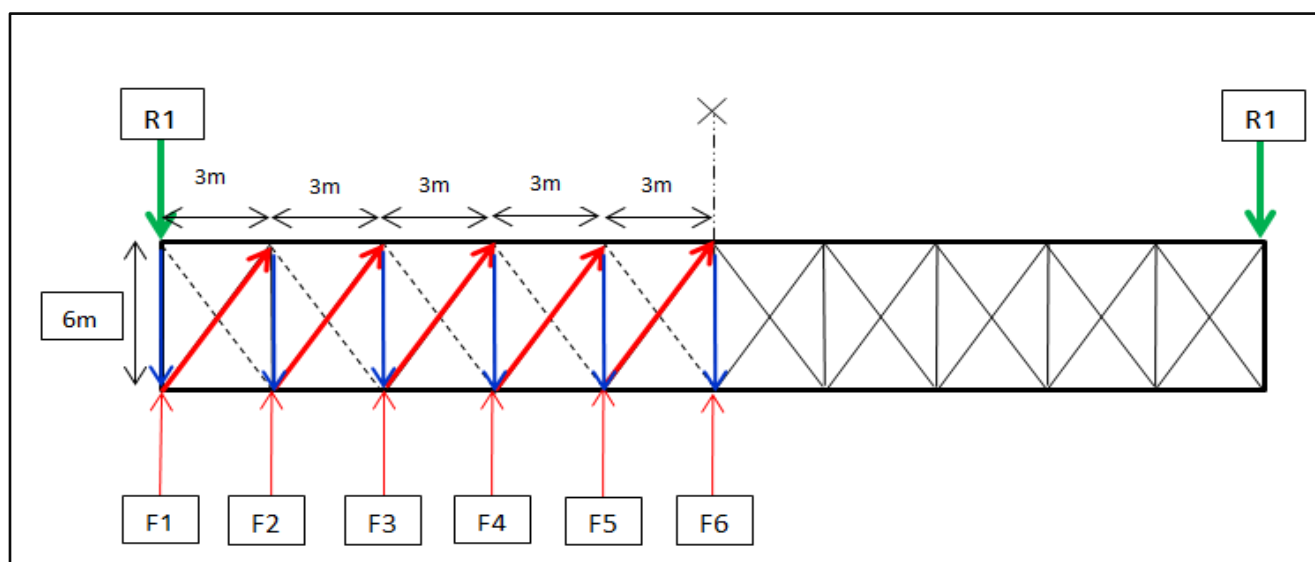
Schéma statique de la poutre au vent (effet de traction).
